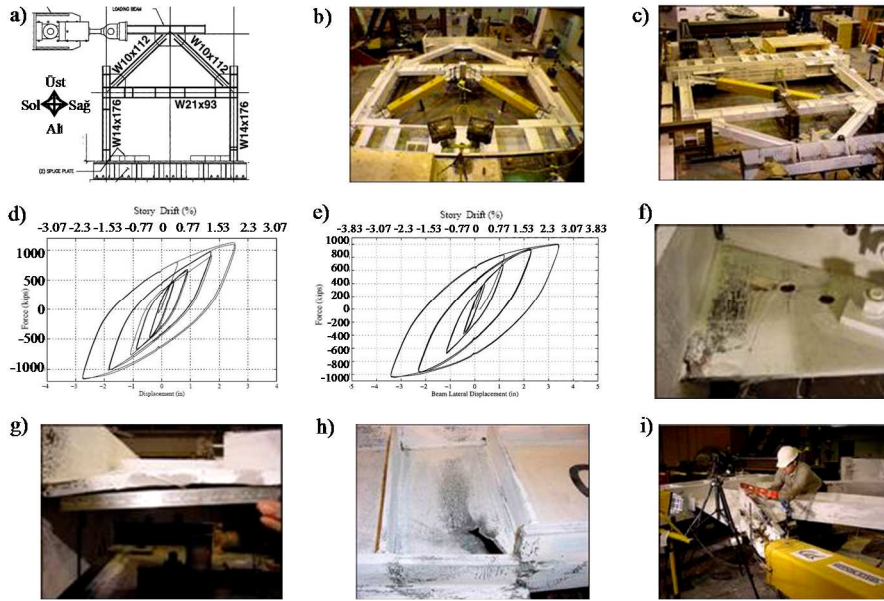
a) Beton-boru profilden oluşan BEM'li BEÇÇ'ler,
